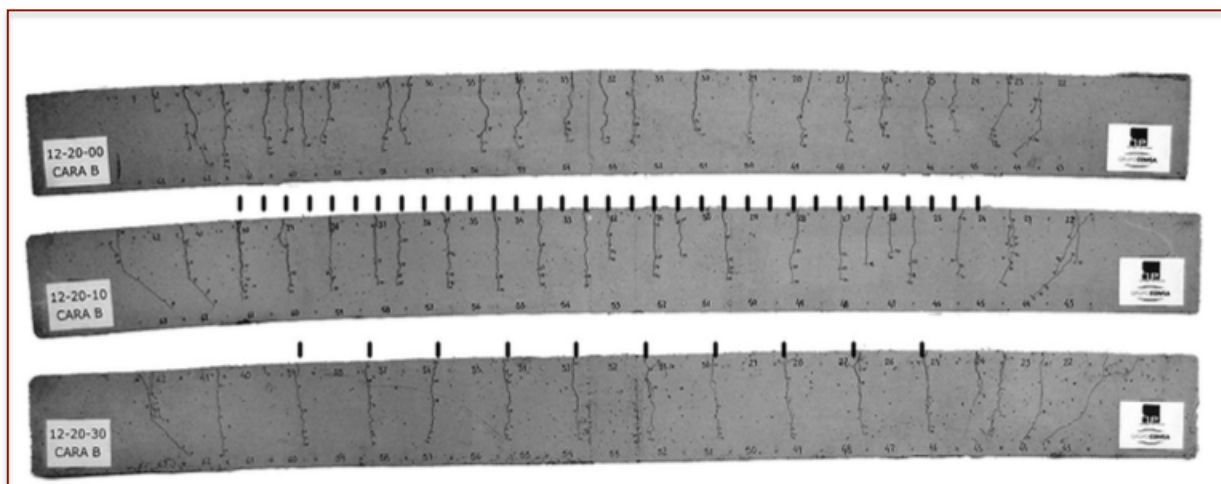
Efeito do espaçamento entre estribos no espaçamento de fendas, em vigas de diâmetros de 12 mm de armadura longitudinal (c=20 mm) [7].
